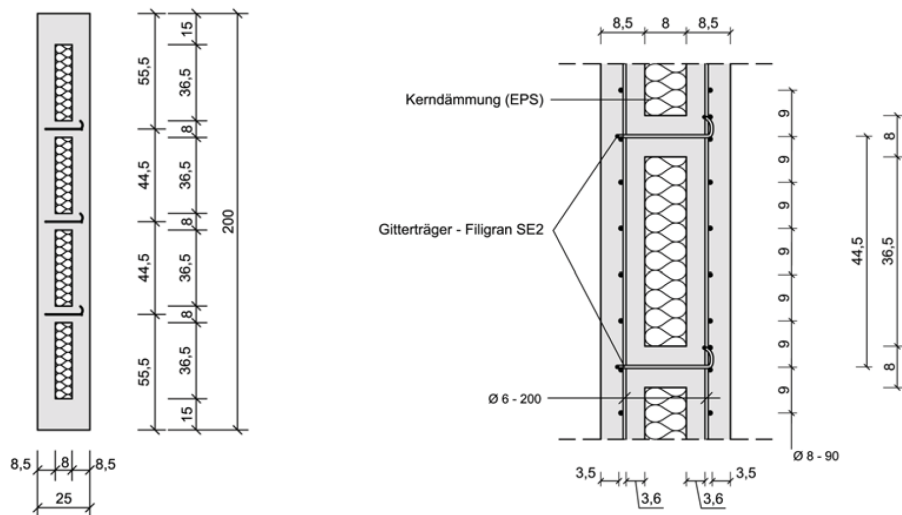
Konstruktionsentwurf mit Gitterträgern in den Betoninnenstegen (Typ 3) (Nguyen 2008)
